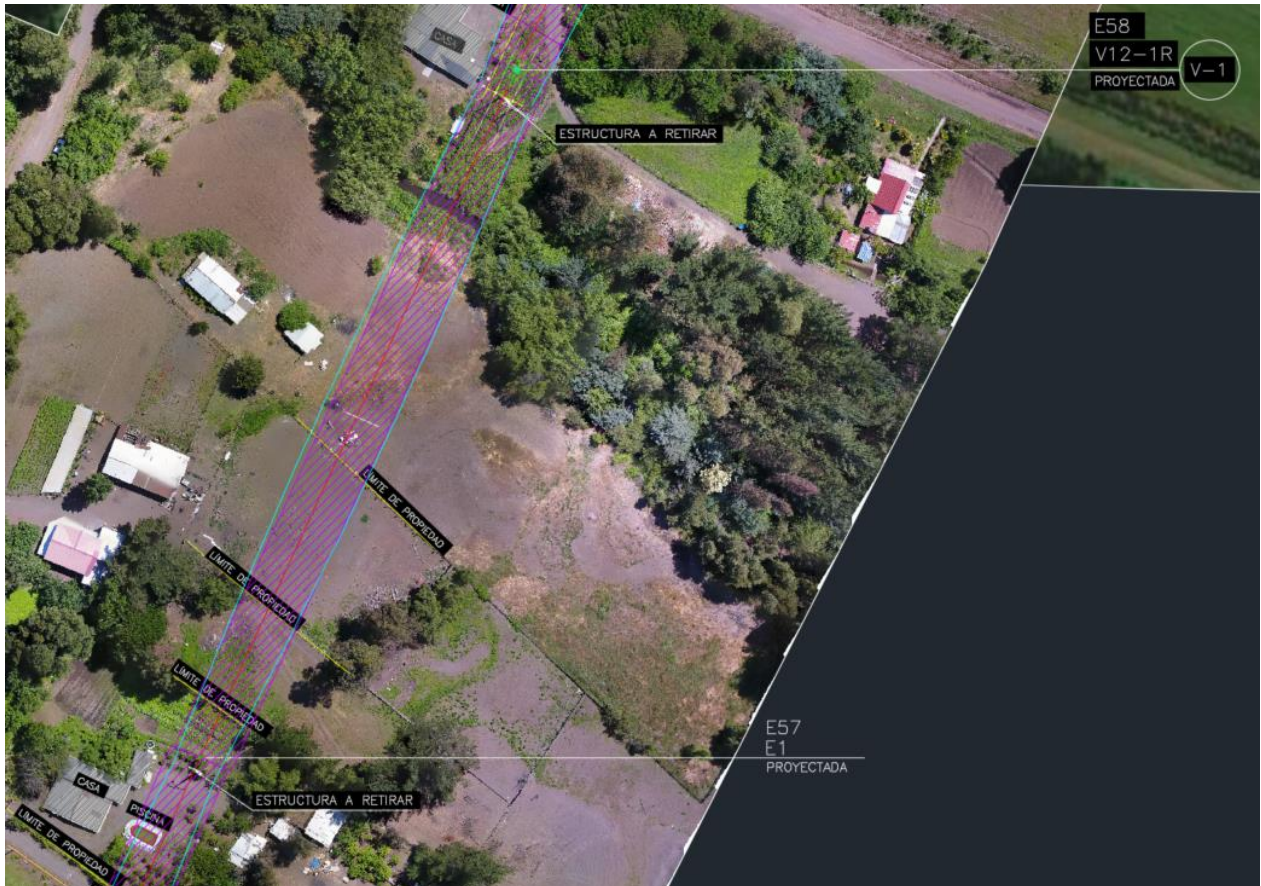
Tramo entre E55 – E60 (proyectado)
